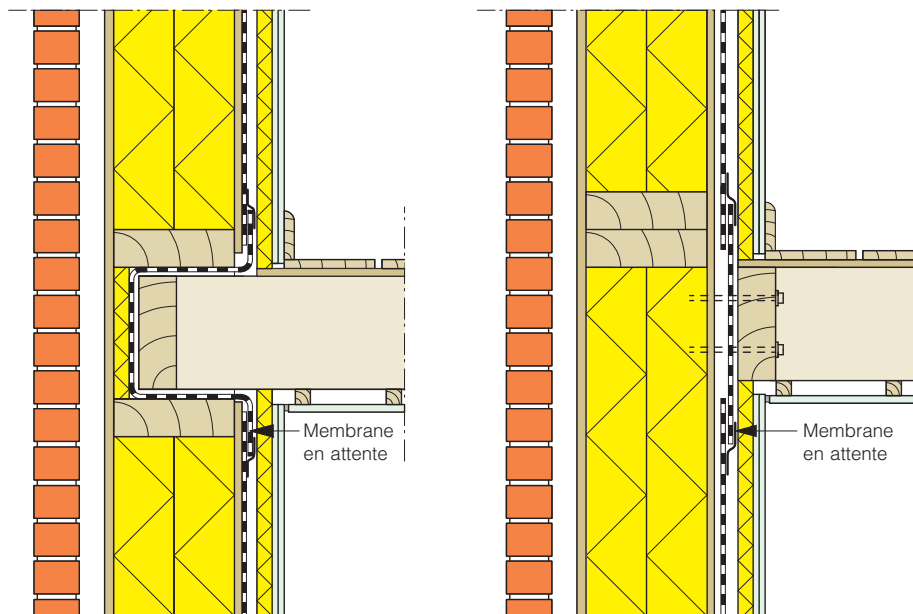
Raccord entre une paroi à ossature en bois et un plancher d'étage en bois
